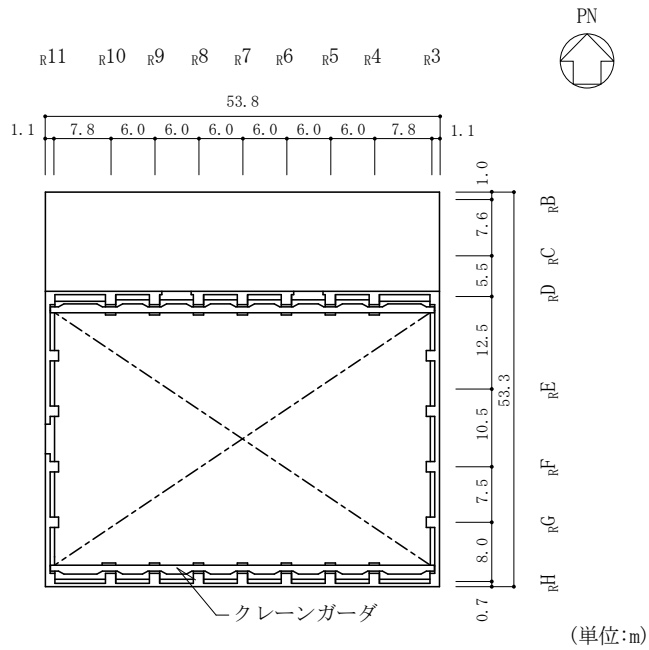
(8) 原子炉建物の概略平面図 (EL 51.7m)
